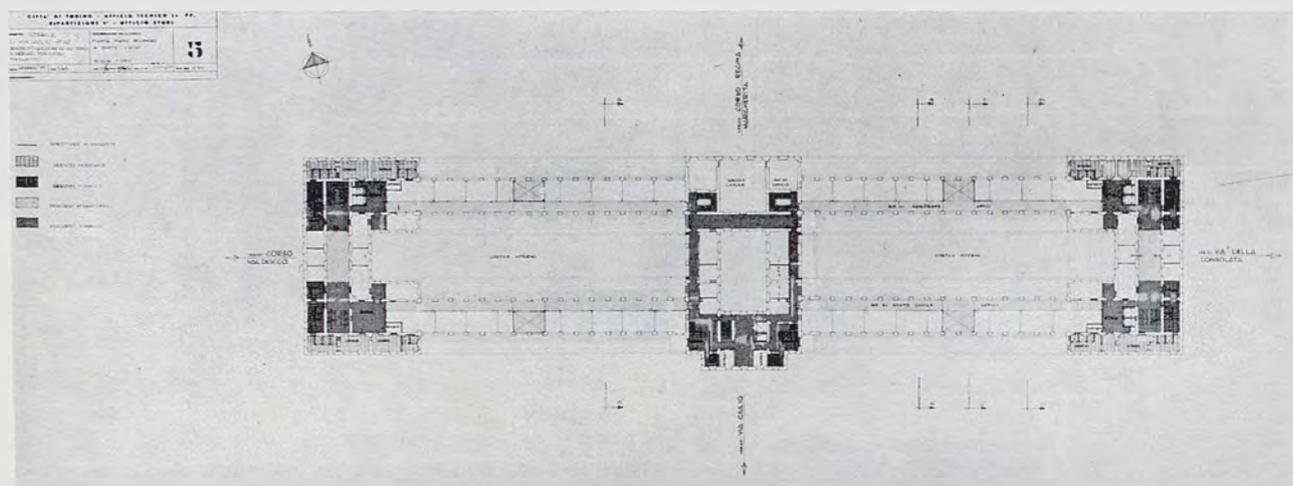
d - Il progetto di ristrutturazione: pianta del secondo piano.
